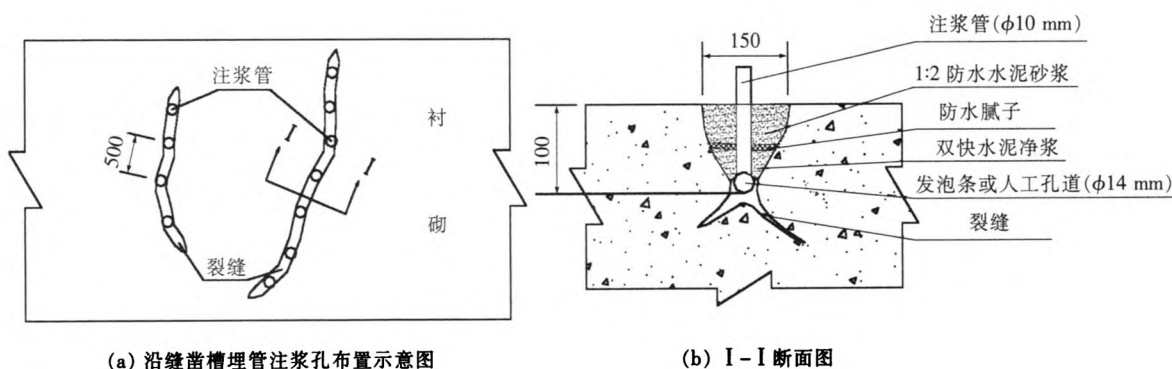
混凝土裂缝内注浆堵缝图(单位:mm)
